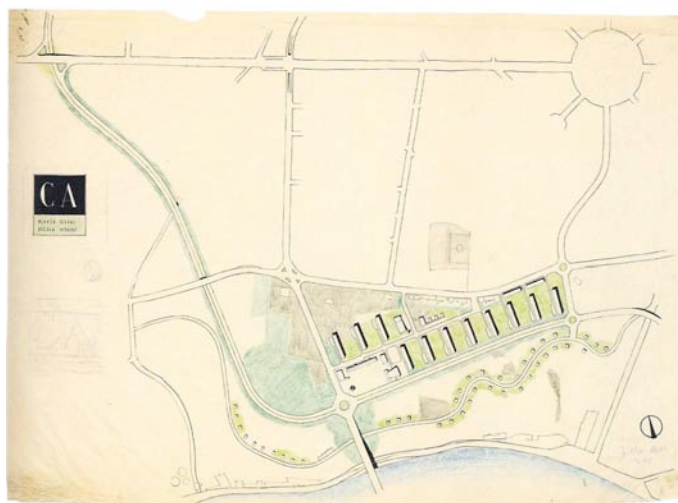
Plano do Campo Alegre. Planta geral, Julho/Agosto de 1948. (Bandeirinha, 2012, p. 199)
